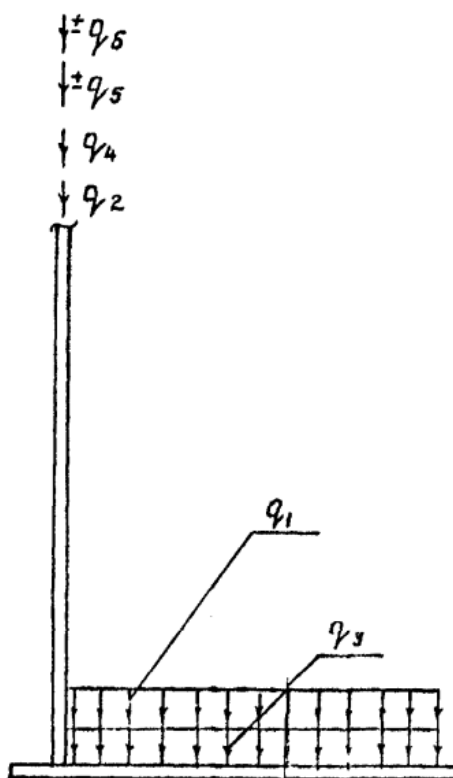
Схема навантаження на фундамент під резервуар
